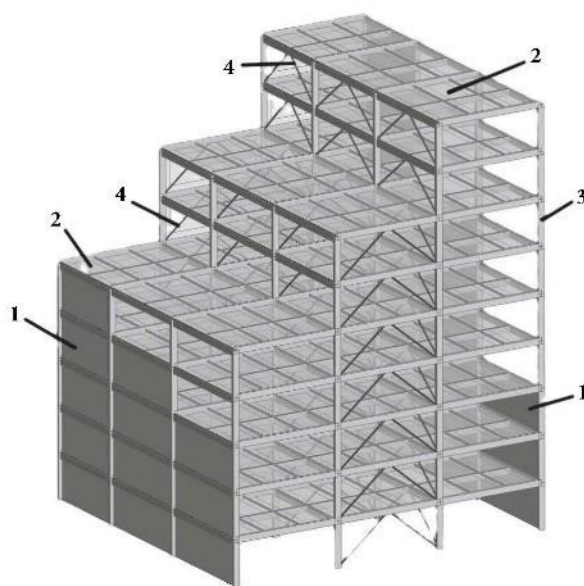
Пример комбинированного каркаса из деревянных конструкций, со стеновыми дисками и (или) перекрытиями из деревянных панелей, с металлическими раскосами: 1 – стеновые деревянные панели; 2 – деревянные панели перекрытия; 3 – деревянный каркас; 4 – металлические элементы связей
